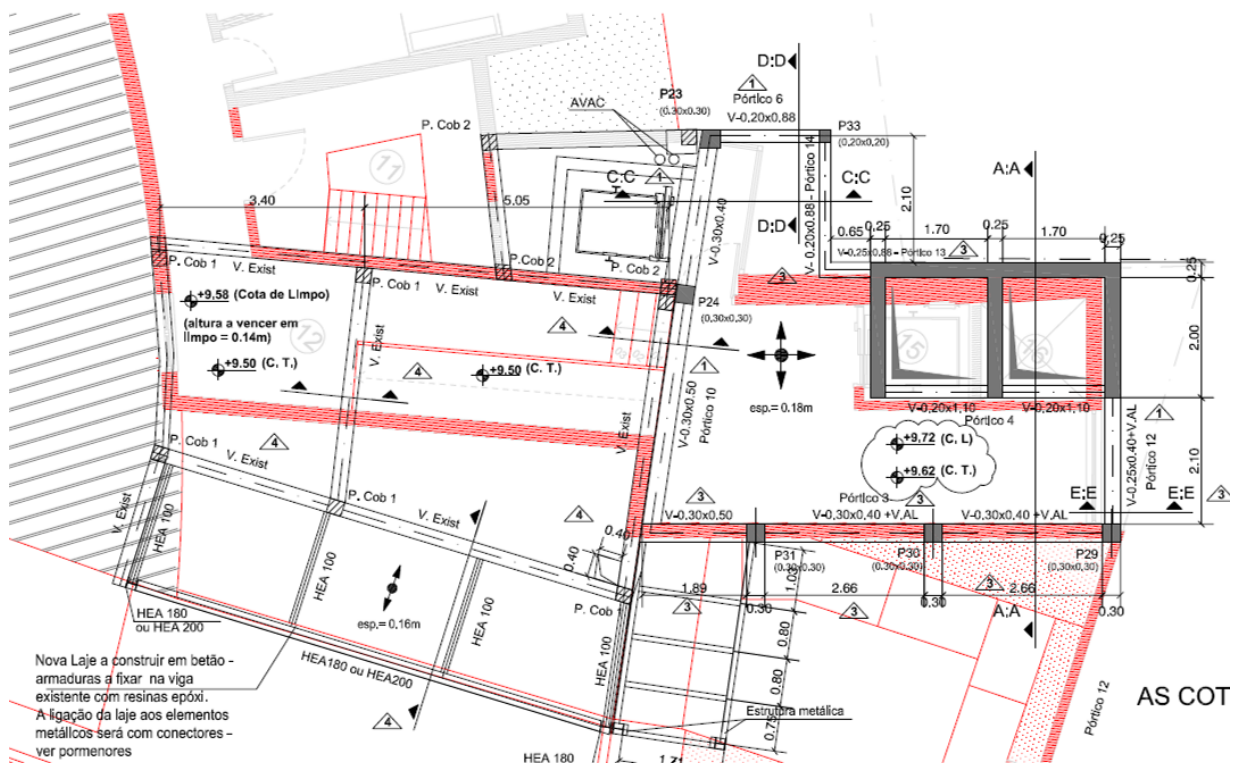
Planta de piso 3 - preparação dos trabalhos [AVicêncio A, 2017]
